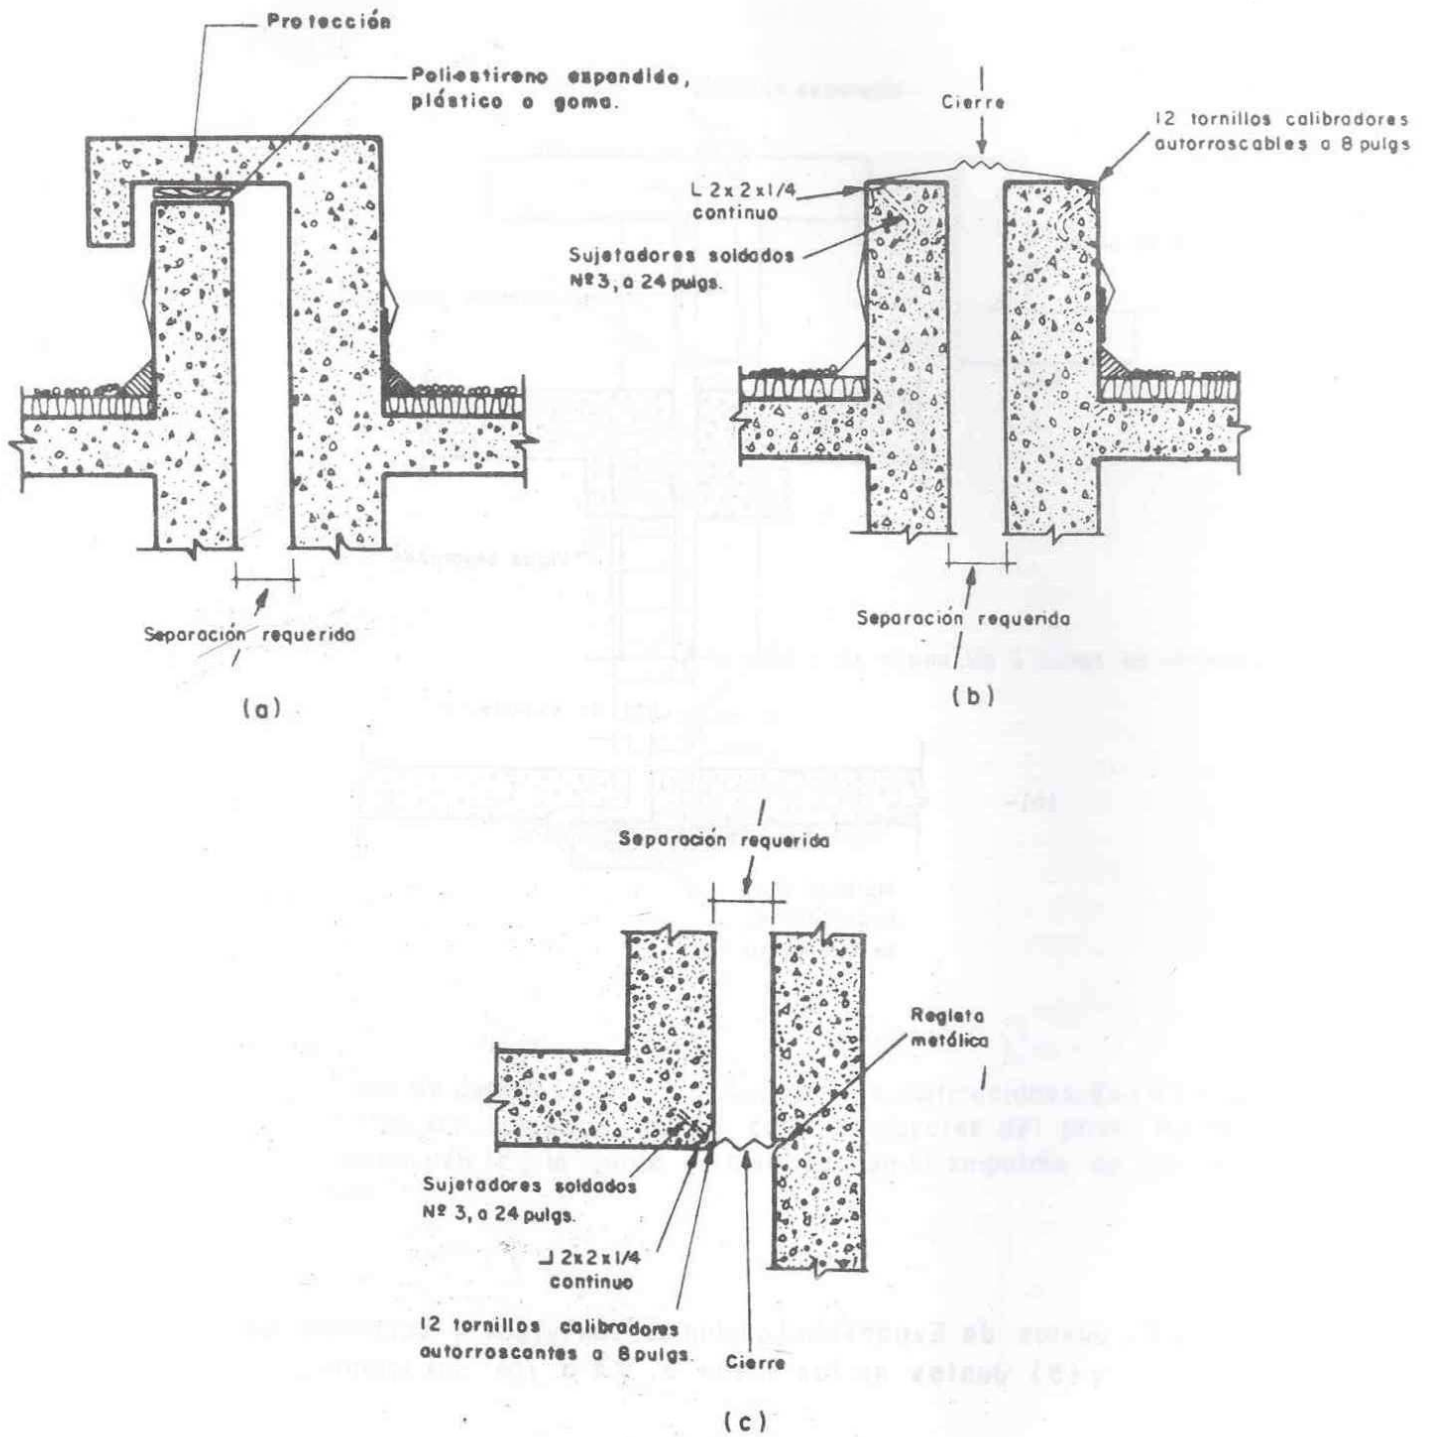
Detalles de Juntas de Expansión.(a) y (b) en Techos,(c) en Interior...
